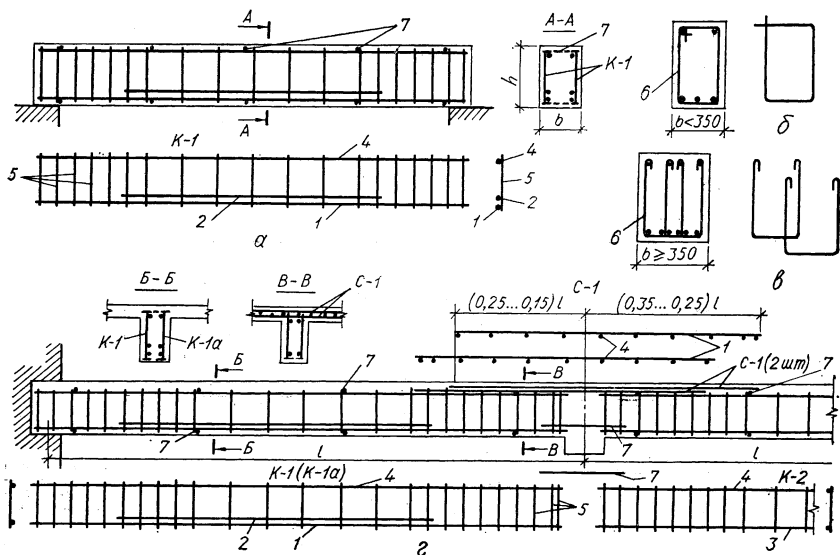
Арматування залізобетонних балок: *а* – армування однопрольотних балок, що вільно лежать, зварними каркасами; *б* – закриті двозрізні хомути; *в* – те саме, відкриті чотиризрізні; *г* – армування нерозрізної багатопрольотної балки зварними каркасами і сітками; 1...3 – поздовжня робоча арматура; 5 – поперечні стержні; 6 – хомути; 7 – сполучні стержні
